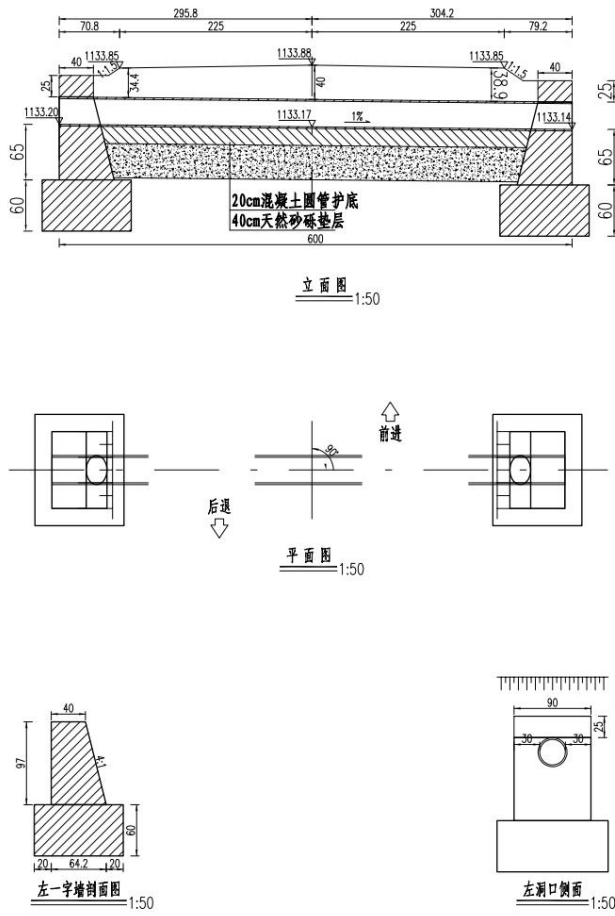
1-0.1m 钢筋混凝土圆管涵布置图
